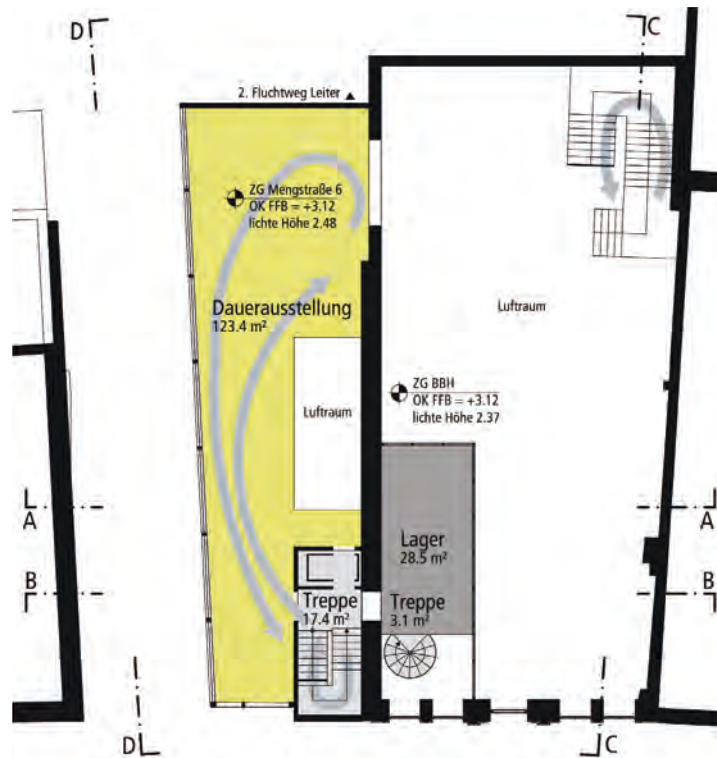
Variante 3, Grundriss Zwischengeschoss
